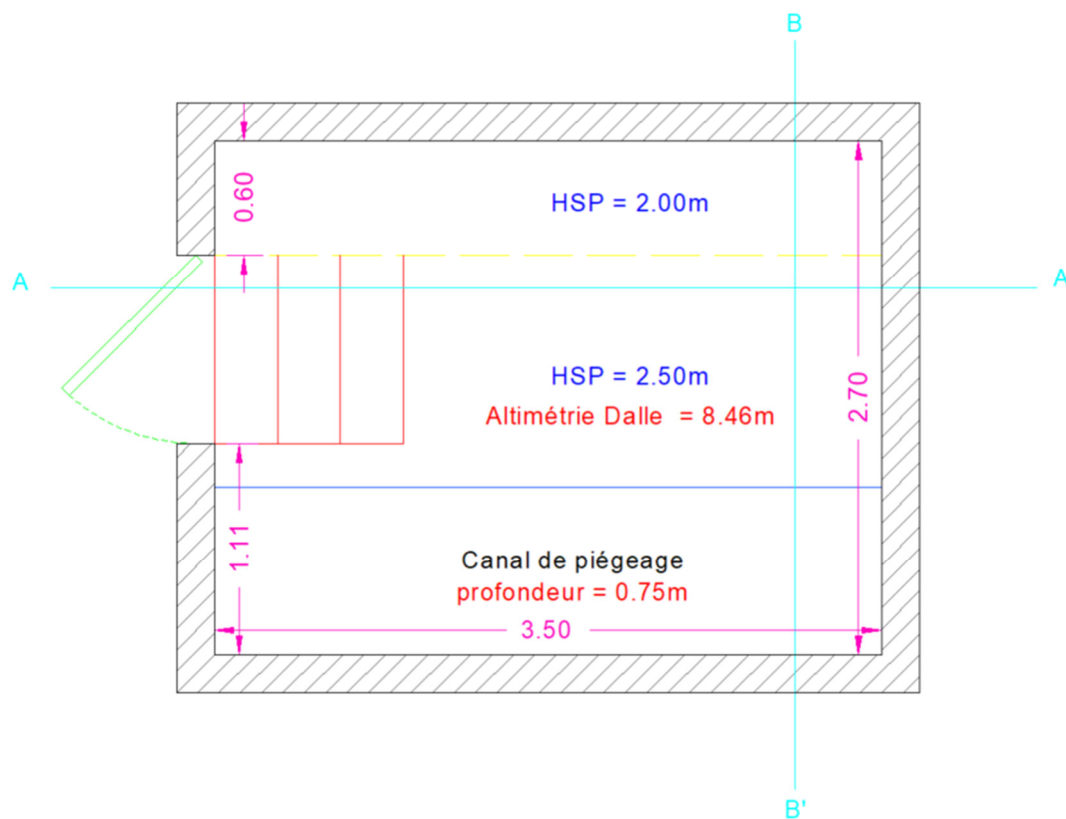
Vue en plan du local de comptage de la passe à anguilles
